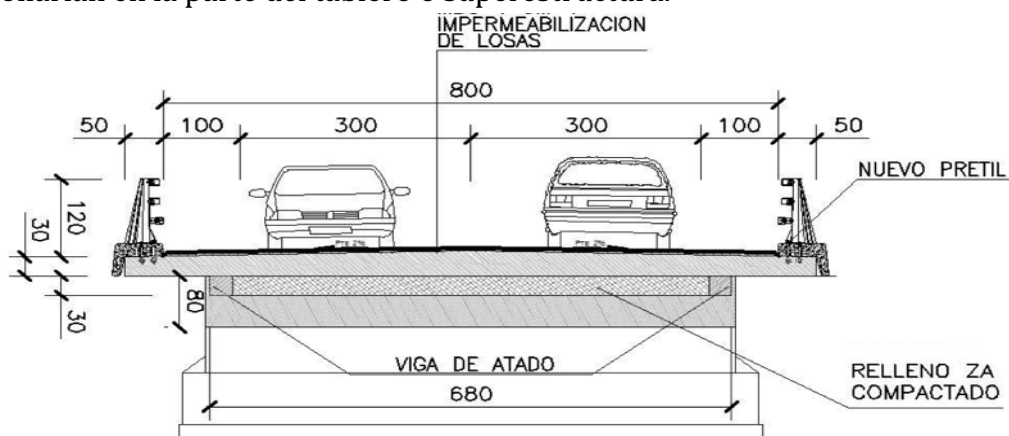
Sección transversal, losa IN SITU y vigas de atado. ^[18] (Barrientos)
